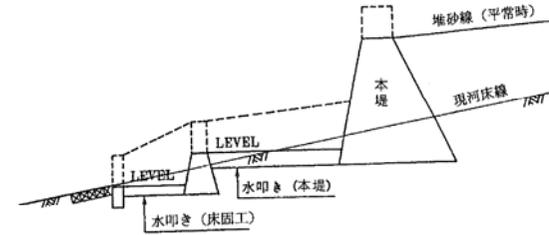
取合工事例1（床固工を設けて落差処理を行う場合）
